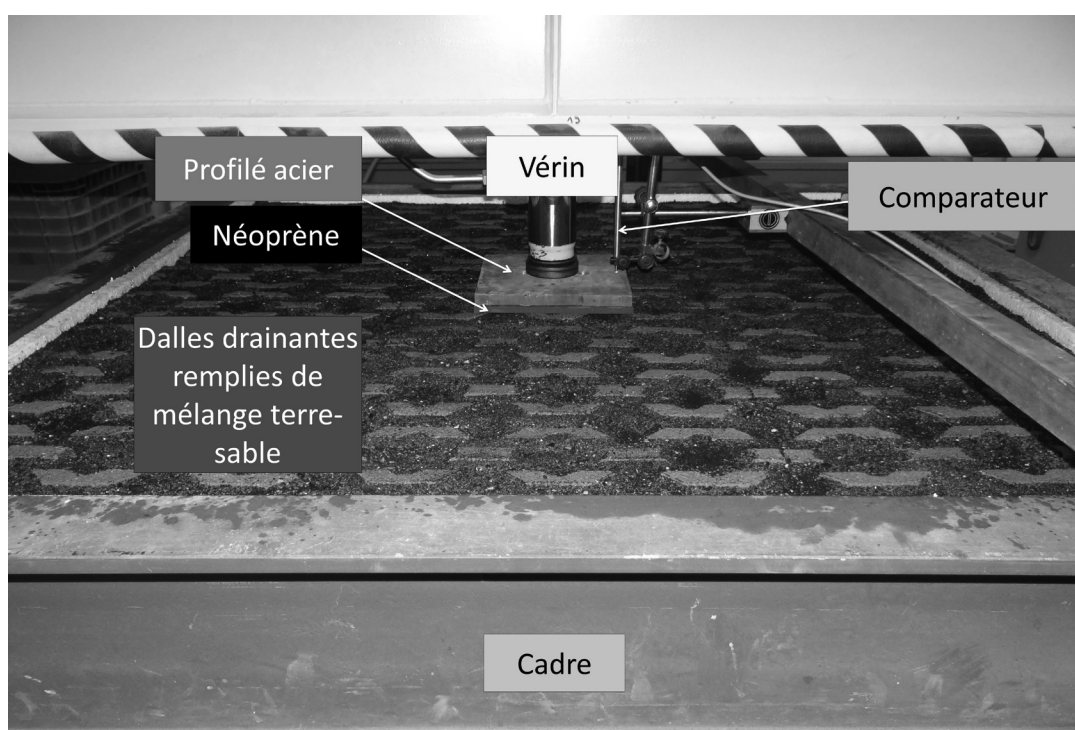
Schéma du dispositif d'essai en conditions de pose sur dalles drainantes
